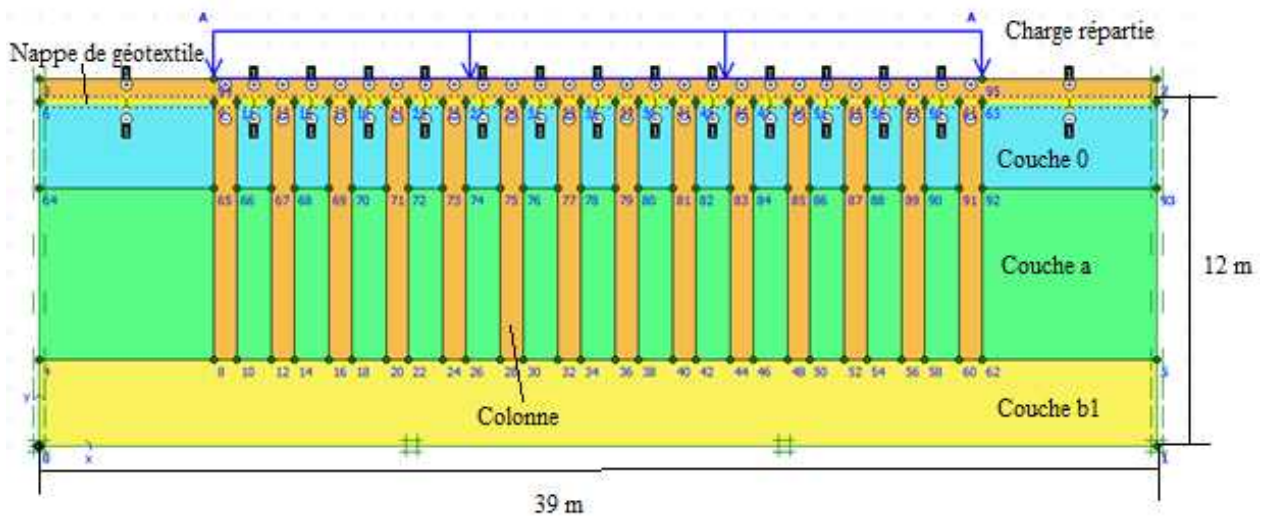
La rampe d'accès reposant sur une nappe de géotextile et des colonnes ballastées
